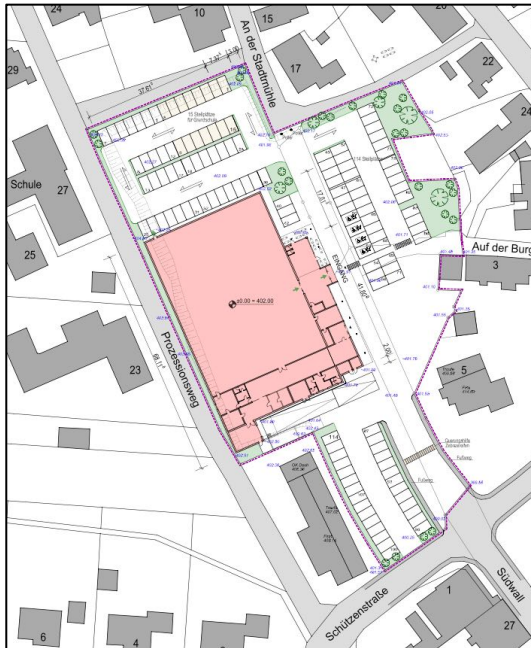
Bebauungskonzept (Architektin: H. Köstersaure, Medebach – Stand: 11/2023)
